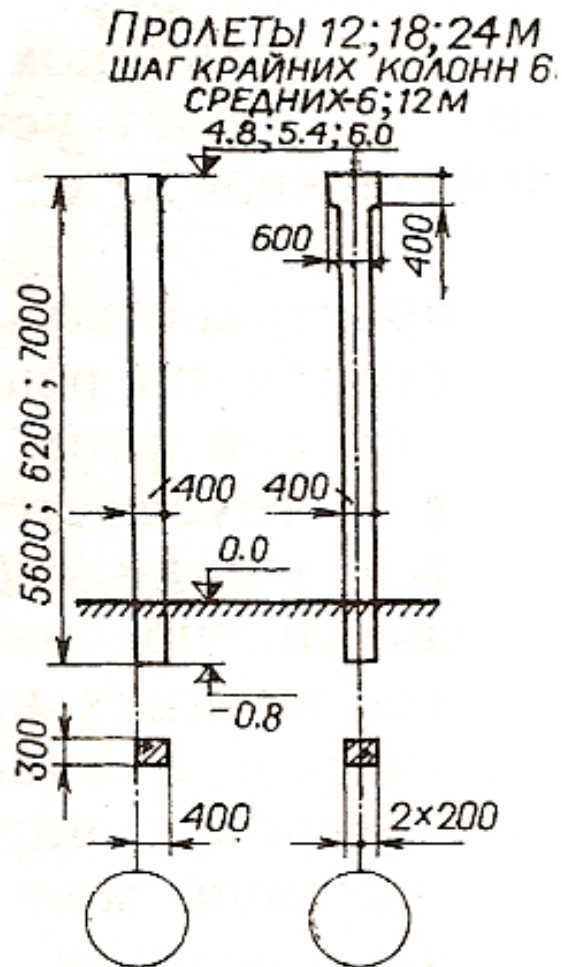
Типы железобетонных колонн для бескрановых зданий
